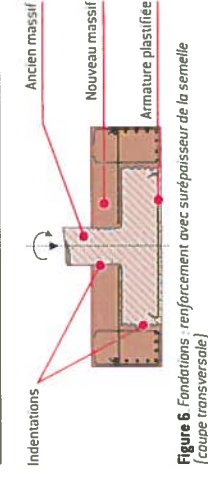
Fondations : renforcement avec surépaisseur de la semelle (coupe transversale)
